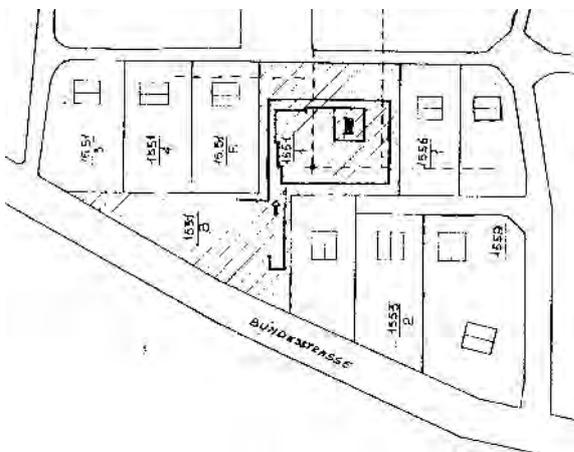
„Lageplan Memorial Gusen“; Einreichplan;
